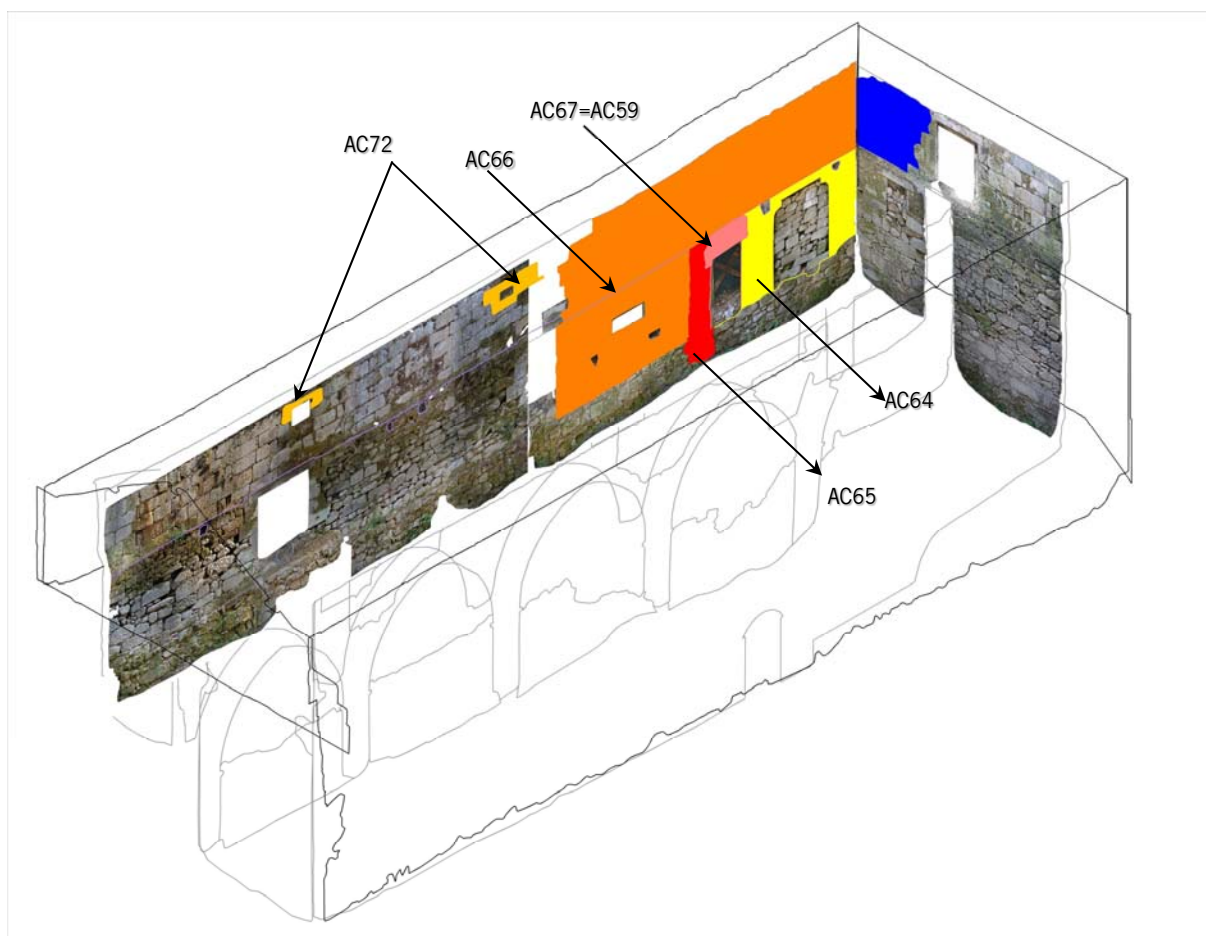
Alçado A07, e A06 ações construtivas associadas a remodelação sudoeste do alçado sul do edifício, vista perspectivada Nordeste.
